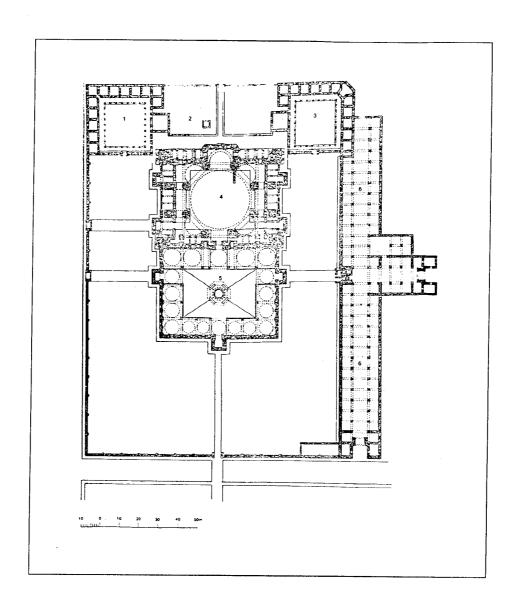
مسقط أفقي لمجمع (كلية) بايزيد الثاني في أدرنة (عن : جودوين) .
